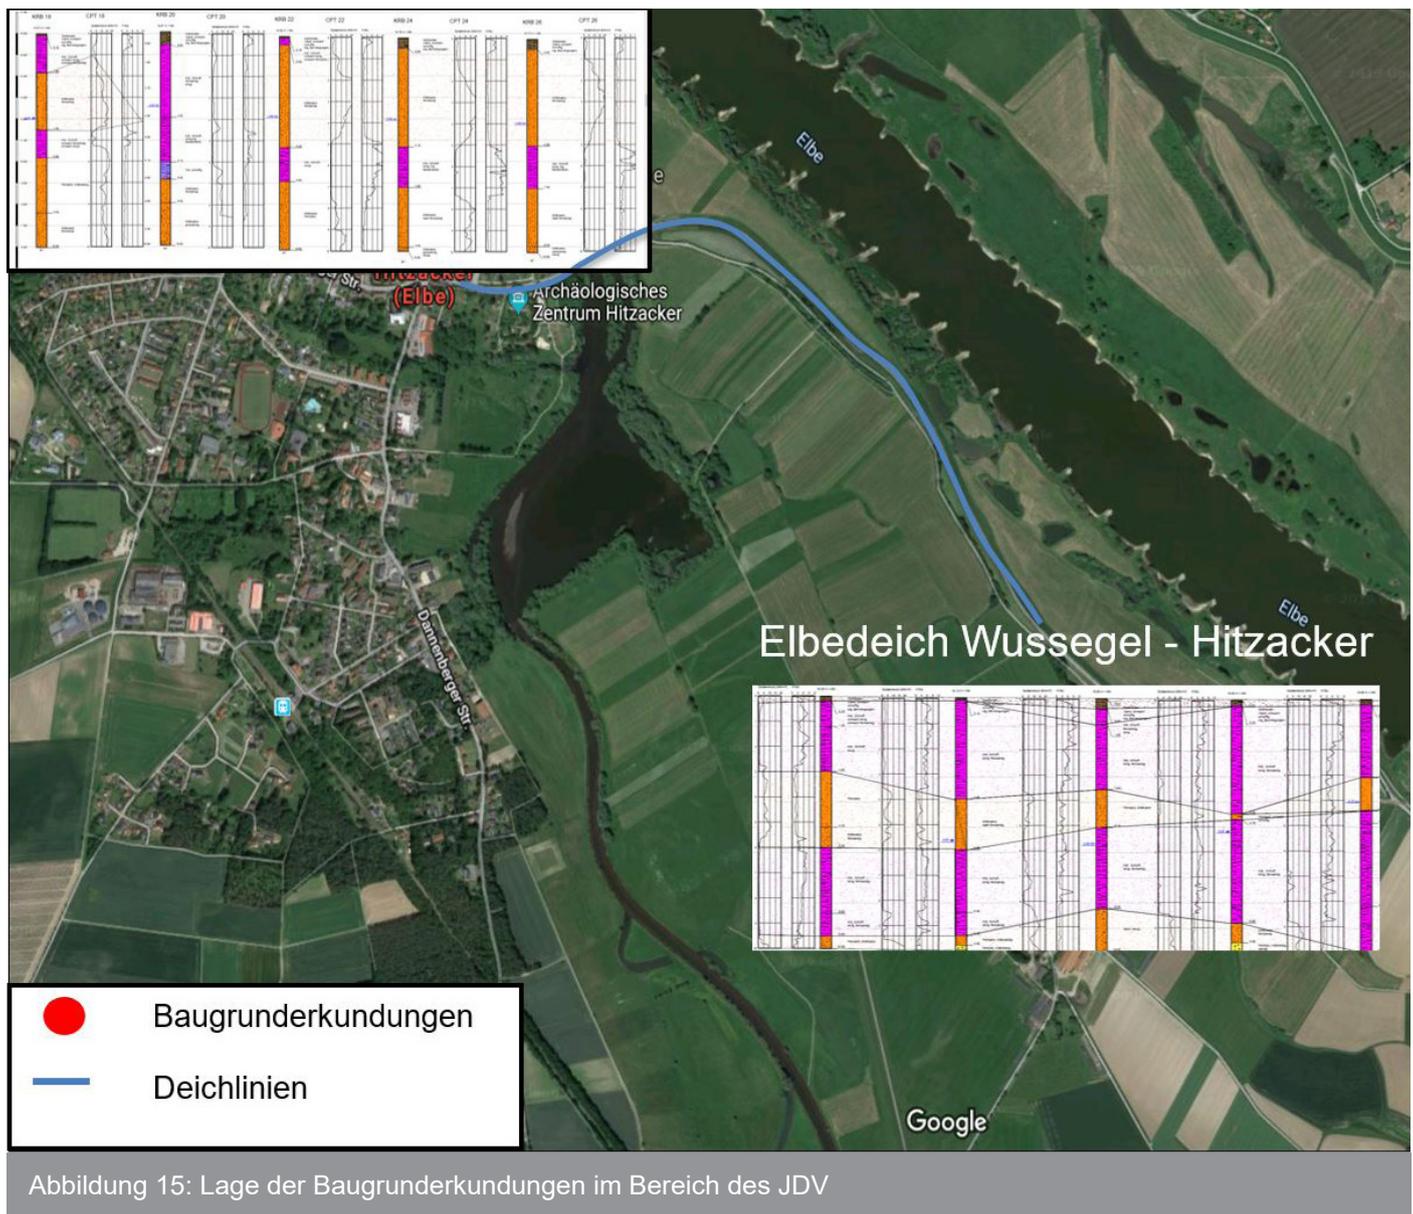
Lage der Baugrunderkundungen im Bereich des JDV
